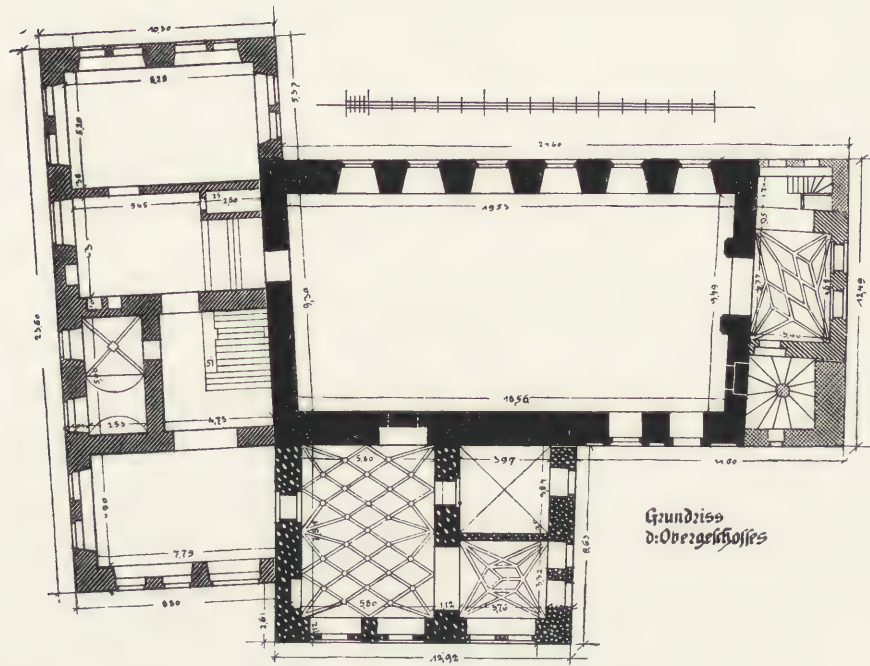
Rathaus zu Gardelegen. Grundriß des ersten Stockwerks.
